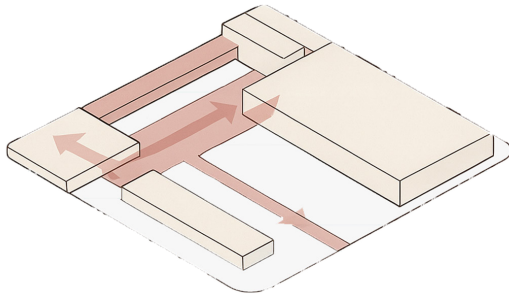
Vista general de edificio del ministerio de vivienda y desarrollo urbano.
